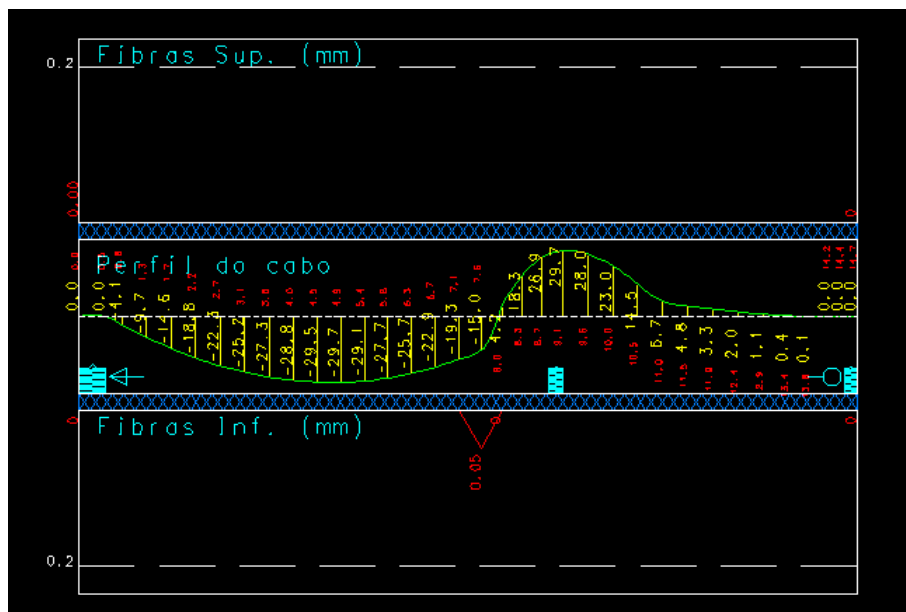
Fissuração viga V11 do 1º pavimento (CAD/TQS)
